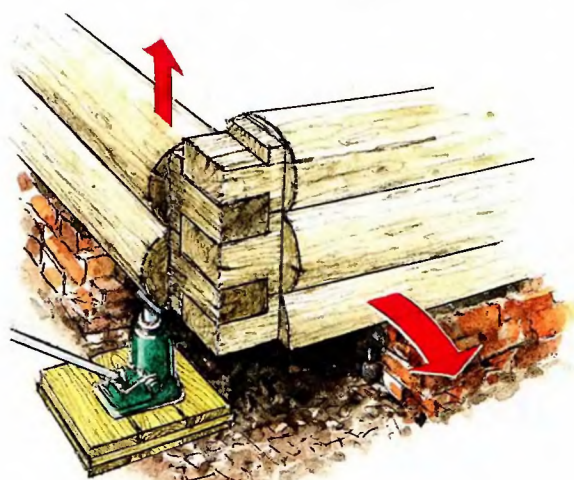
Первым вынули бревно, не зажатое весом сруба. Подошву бревна, лежавшего выше, пришлось подровнять топором, чтобы обеспечить его плотное прилегание к новому брусу обвязки.
